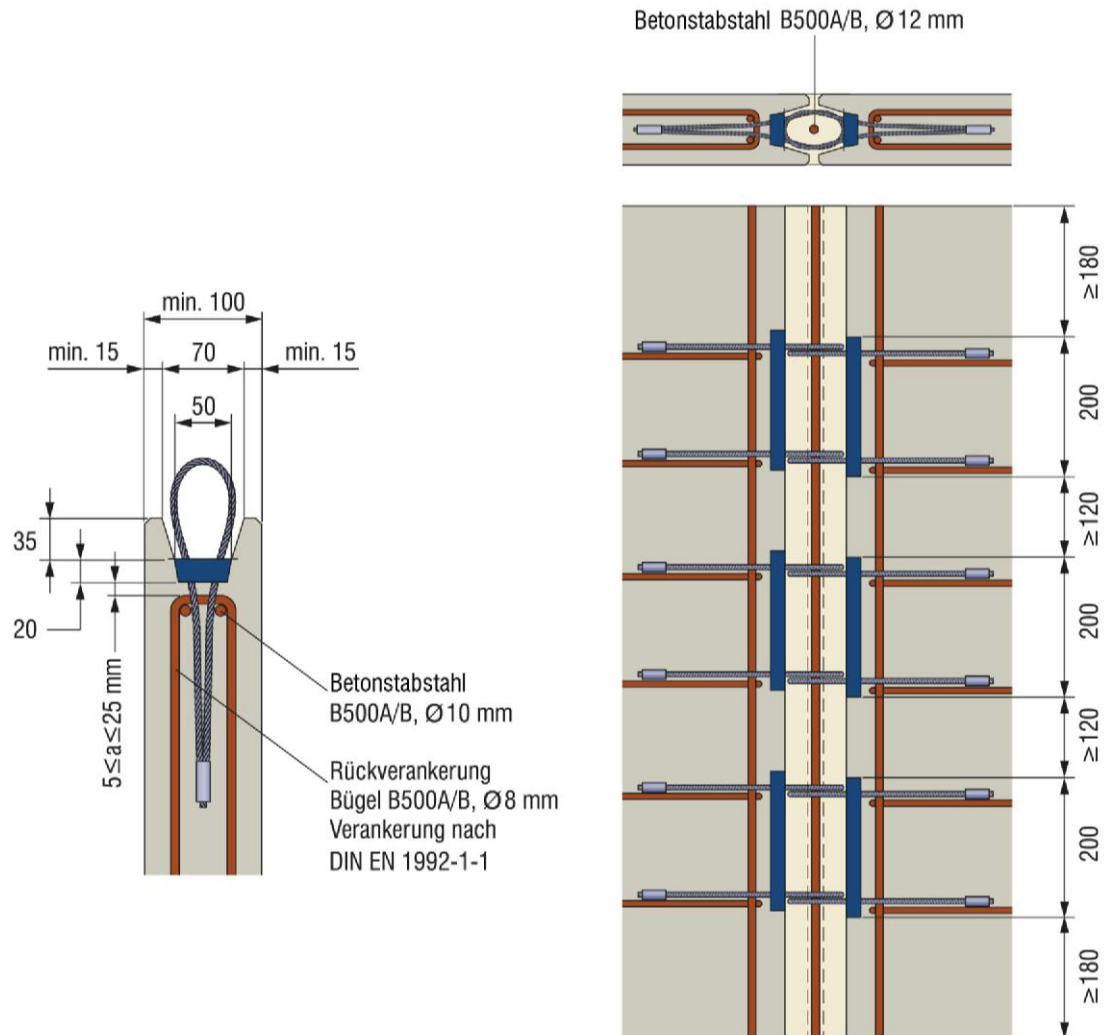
Vergussnut, Bewehrung (Detail Fertigteil A und B)
